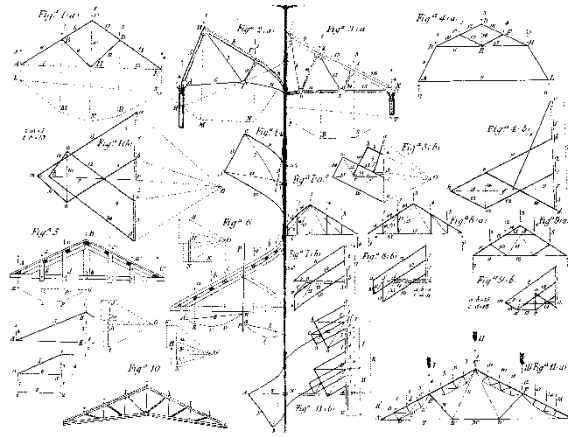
Croquis de cerchas y estructuras de pórtico. Fuente: (Marvá Mayer, 1916).
